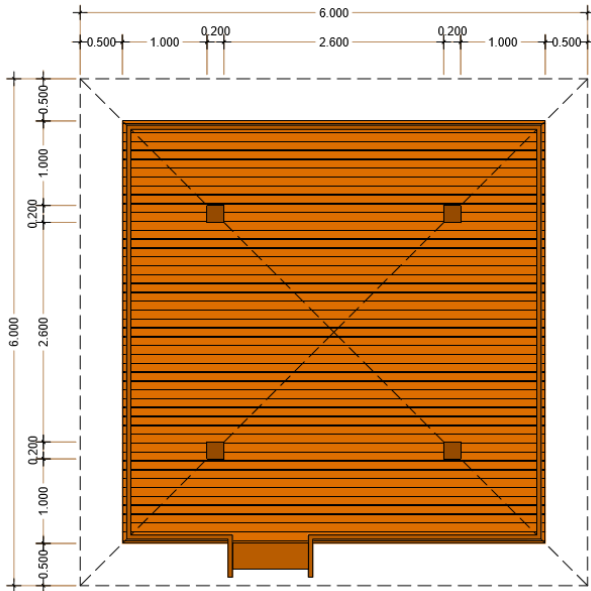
, PLANTA MIRADOR TÍPICO
